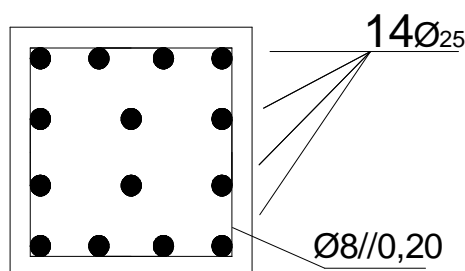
Secção transversal dos pilares P1, P3, P4 e P6
